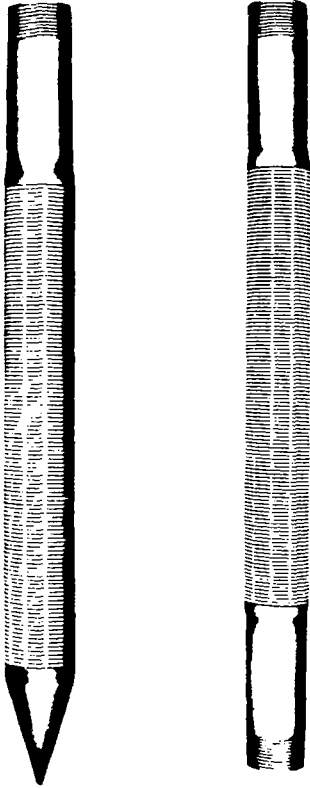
PUNTA COLADORA DEL TIPO DE RANURA CONTINUA Y SECCION DE EXTENSION.
